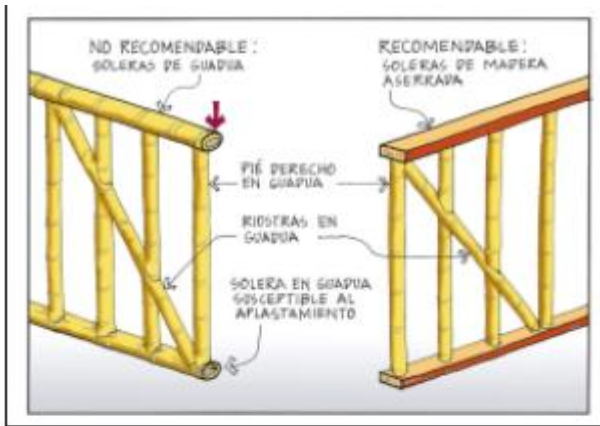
Detalle de Soleras en Muros no estructurales de Bahareque encementado.
